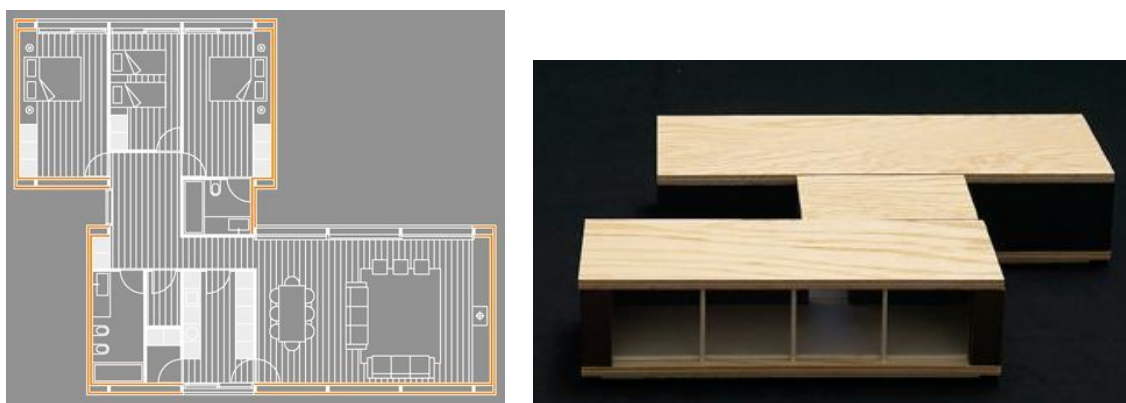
Planta e ilustração 3D da solução standard L.1+ [54]
